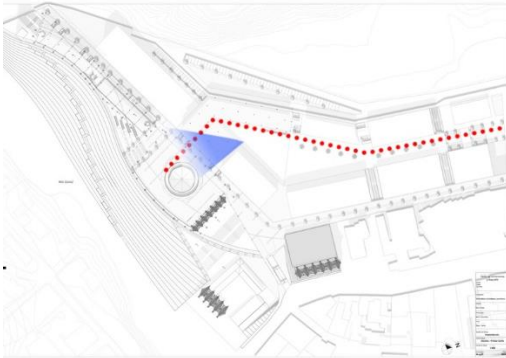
Plano de referencia vista desde la plaza elevada hacia el Centro Histórico. Elaboración propia (2016)
